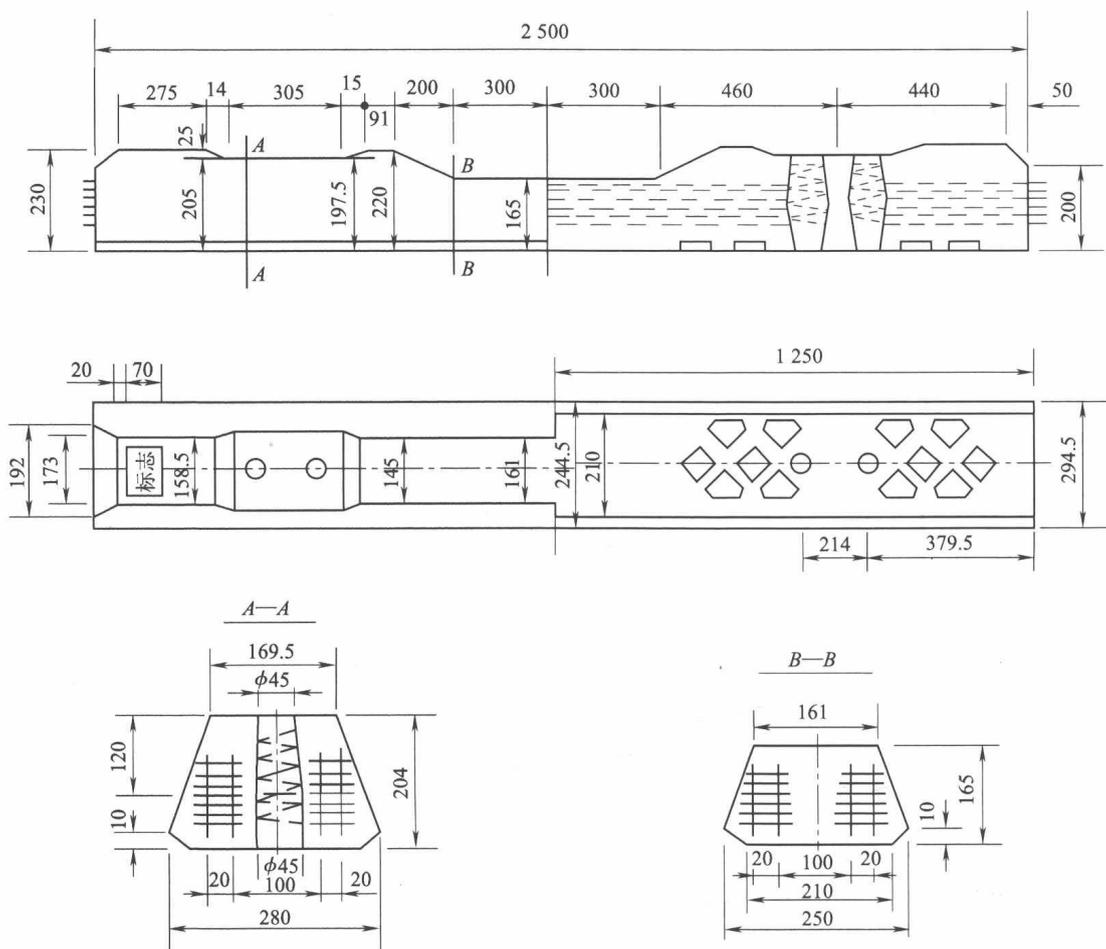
DT1 型预应力混凝土枕(单位:mm)
